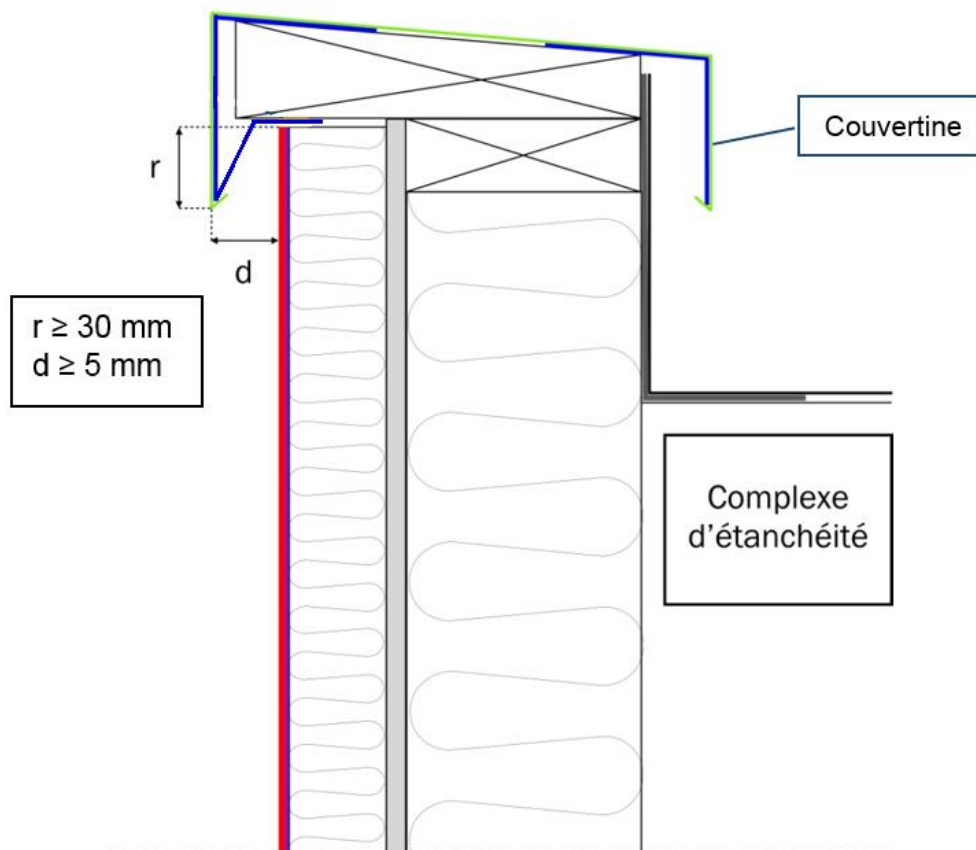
Arrêt haut : protection par couvertine métallique (Ee1) – coupe verticale
